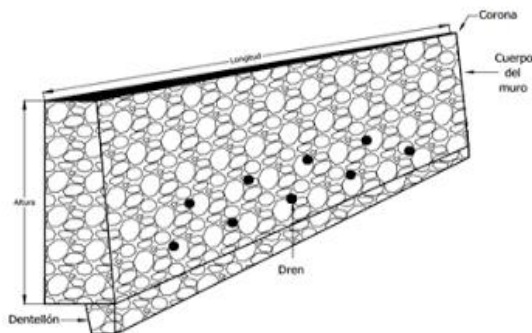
Muro de mampostería de piedra braza con drenes y dentellón, para sitios con riesgo de deslizamiento.
